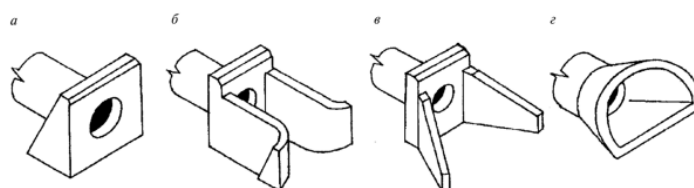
Типы оголовков: а – порталный, б – коридорный, в – раструбный, г – воротниковый
